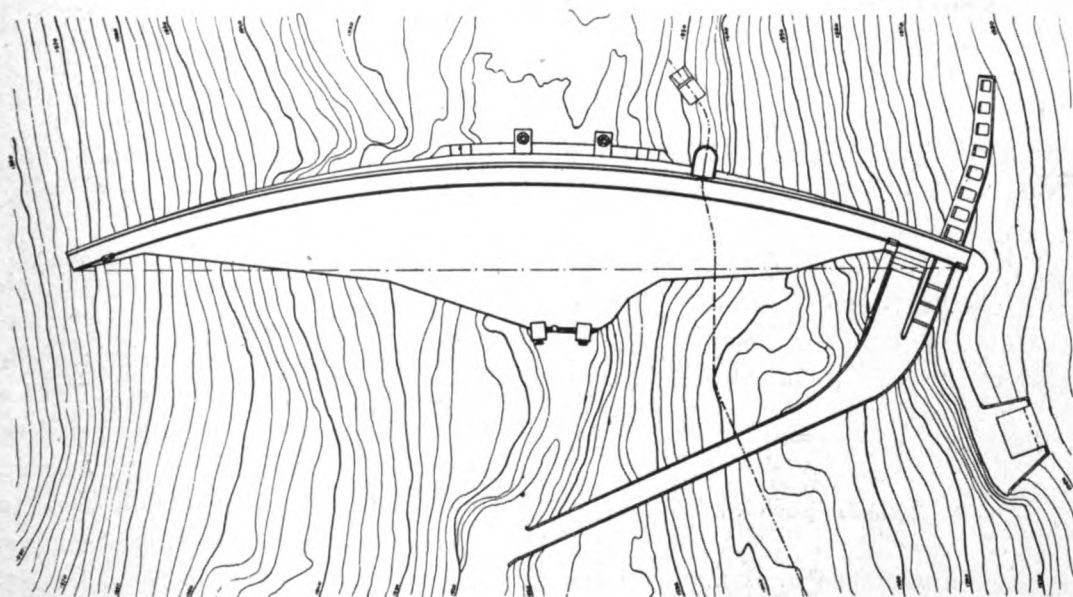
Diga a gravità. Planimetria della diga di Rochemolles
